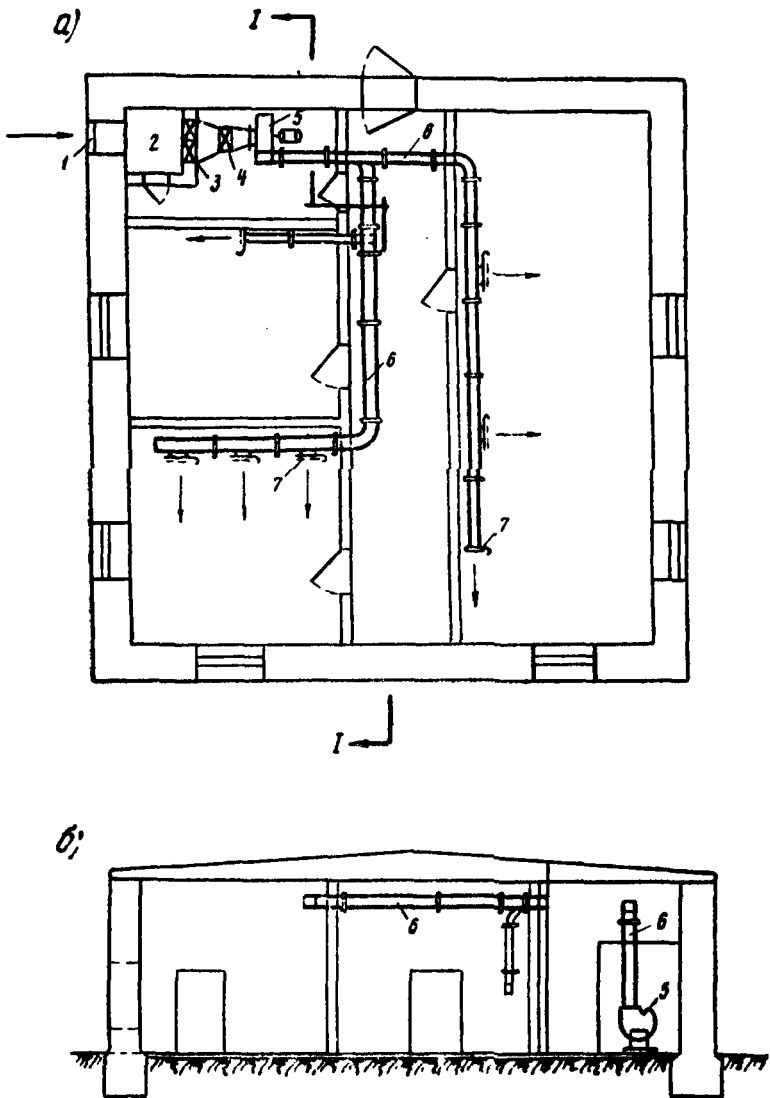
План (а) и разрез (б) сооружения с нанесенными на них элементами приточной системы вентиляции:
